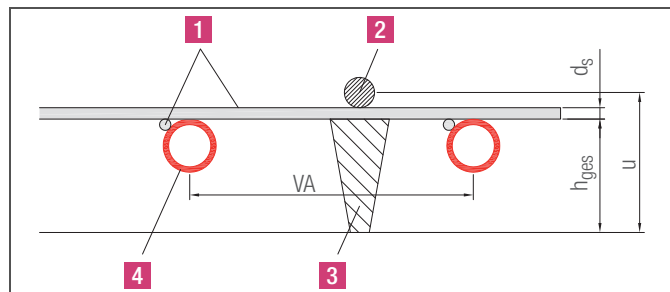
Строение нижней арматуры, разрез (деталь)
